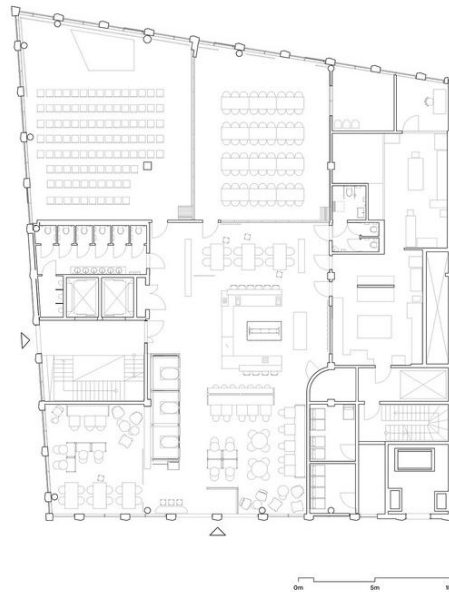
План 1-го Pir Ålesund Office Building [26]
